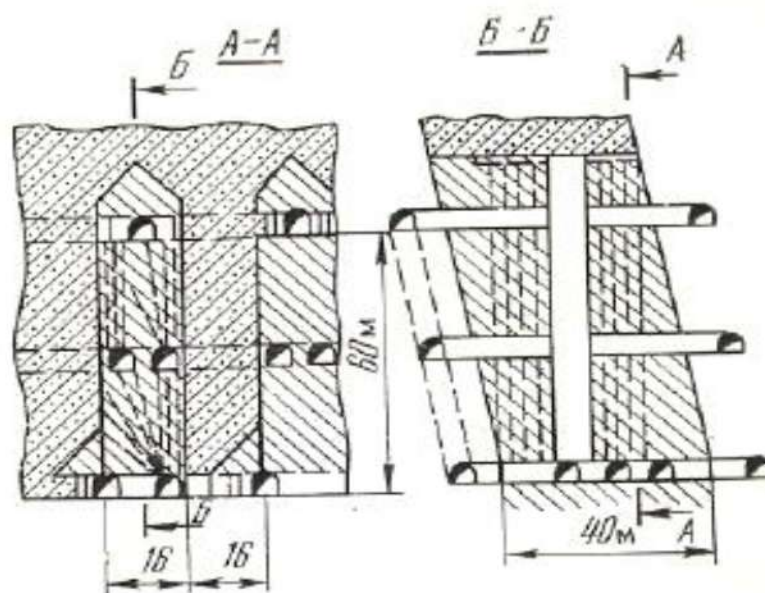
Вариант камерной системы разработки с твердеющей закладкой, отбойкой из подэтажных выработок и самоходным оборудованием (Гайский ГОК)
